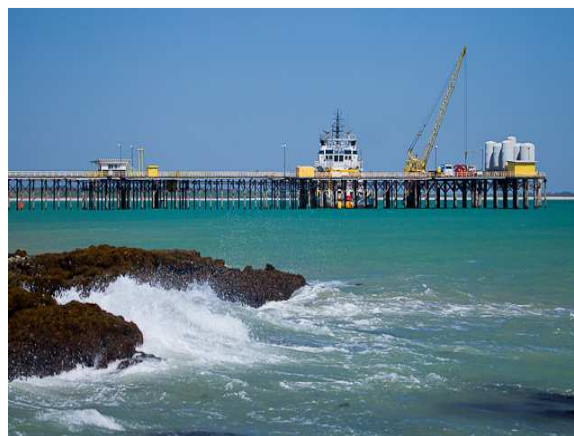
Estrutura do Terminal da Petrobrás na Praia da Pedra Rachada. Paracuru [31].
